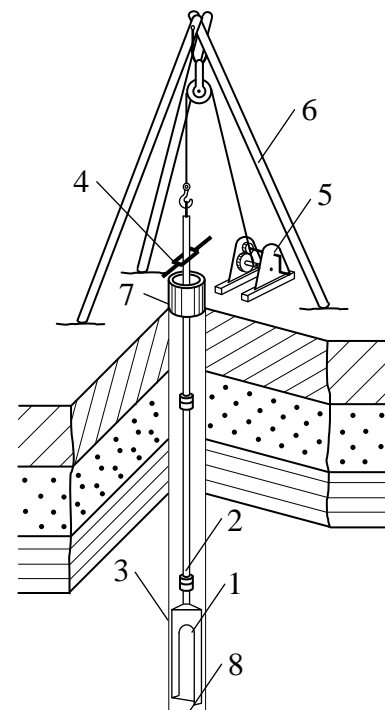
Бурова установка для ручного ударно-обертального буріння: 1 – буровий інструмент; 2 – штанга; 3 – обсадна труба; 4 – хомут; 5 – лебідка; 6 – копер; 7 – устя свердловини; 8 – забій
